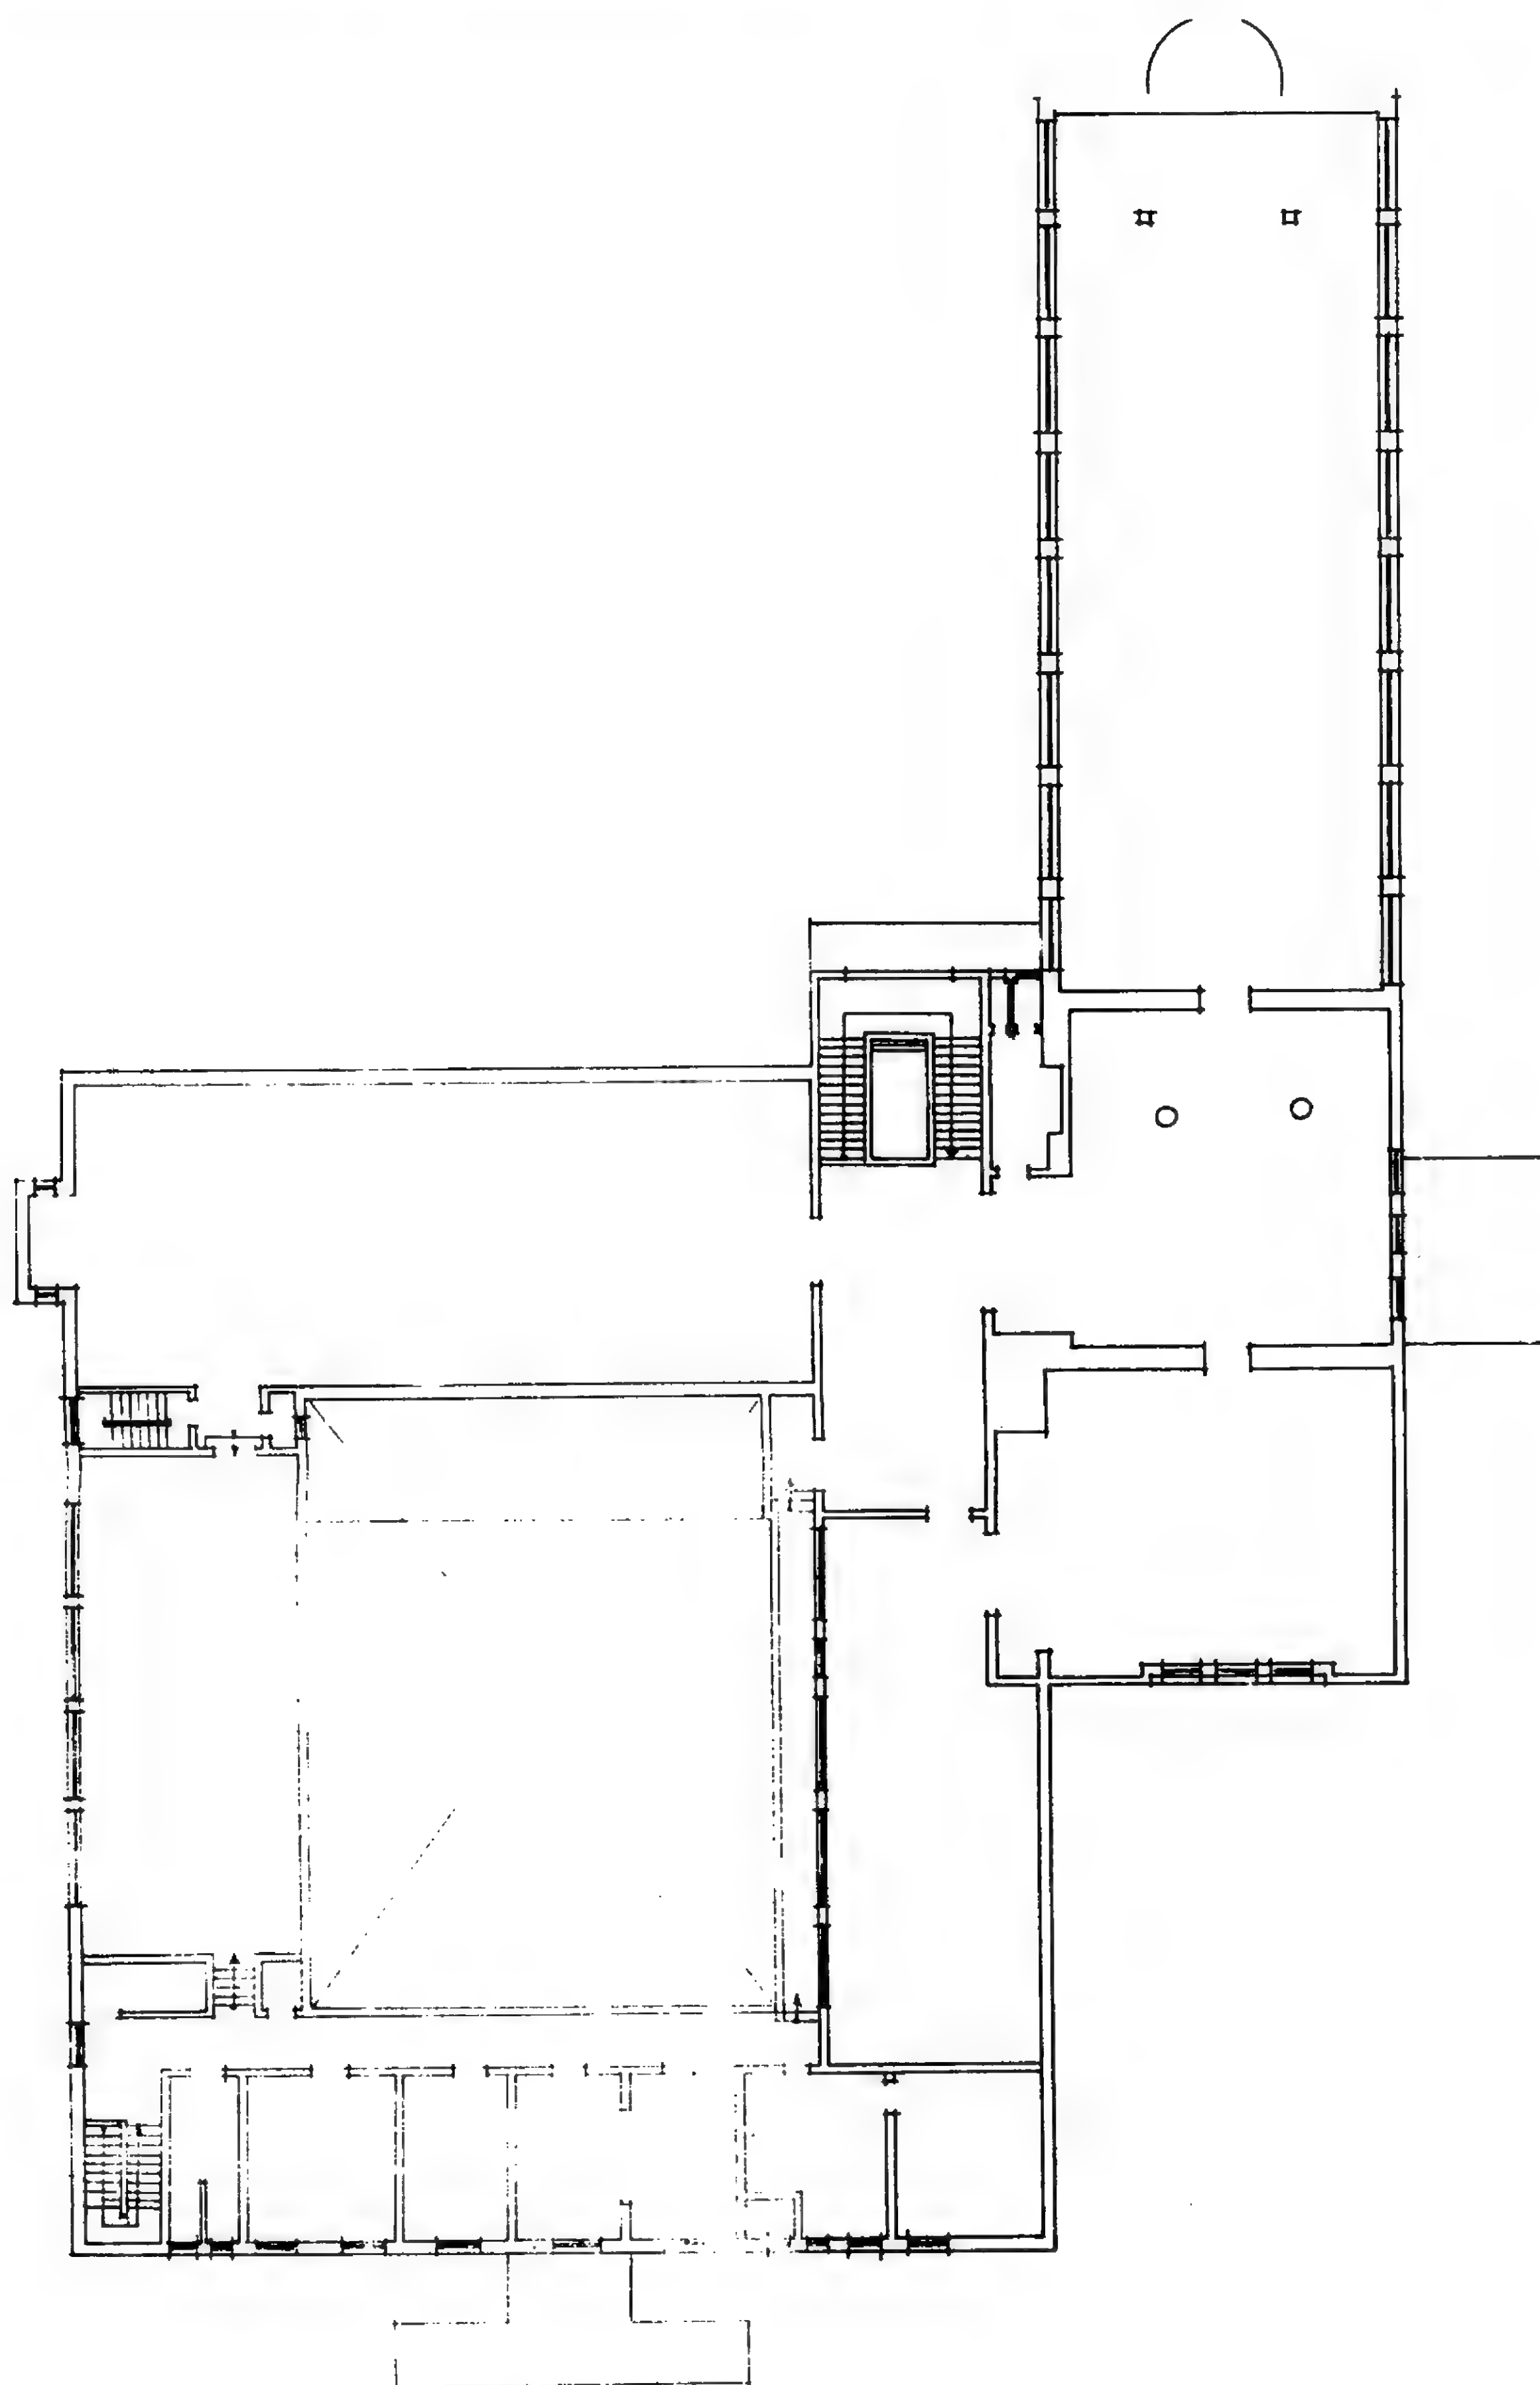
مسقط أفقى للدور الأرضى لمتحف بورسعيد القومى .
